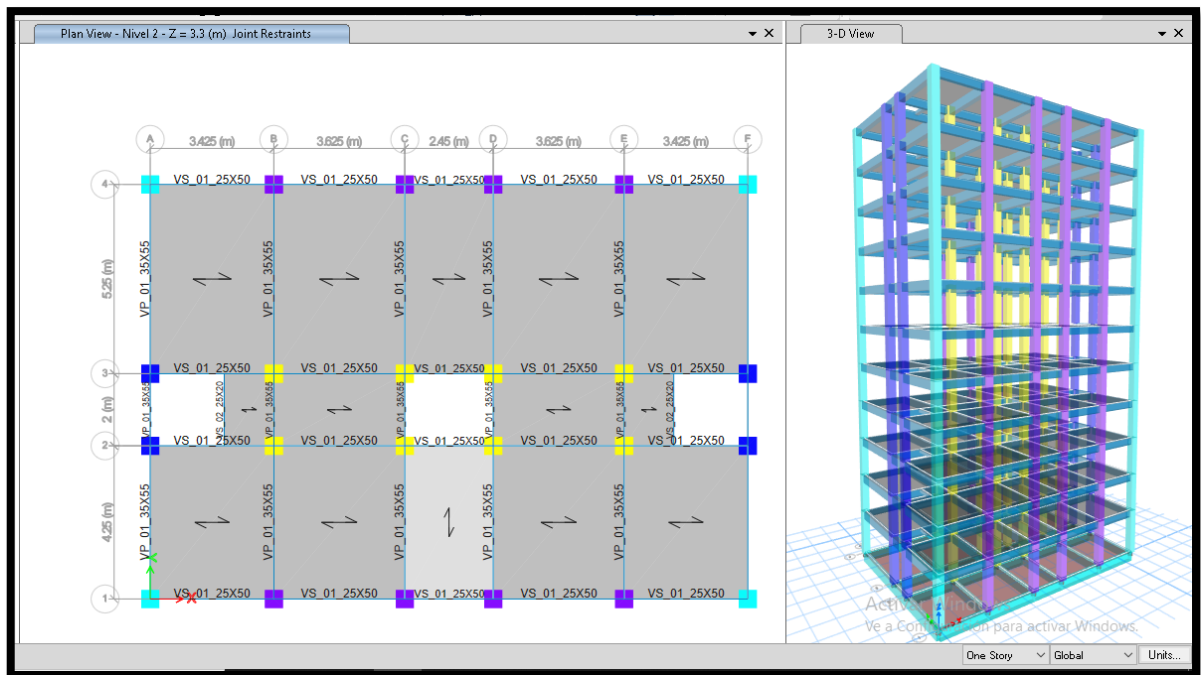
Modelamiento estructural del sistema convencional apertocado.
